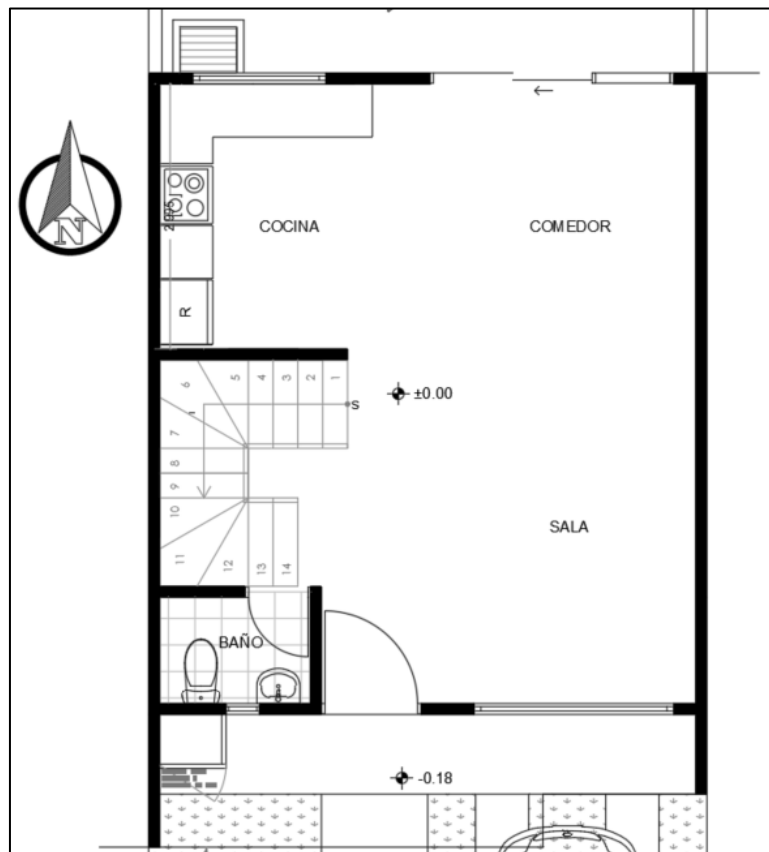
Planta Baja del proyecto de vivienda de interés público (VIP) [Arcilla Conjunto Residencial, 2018]
